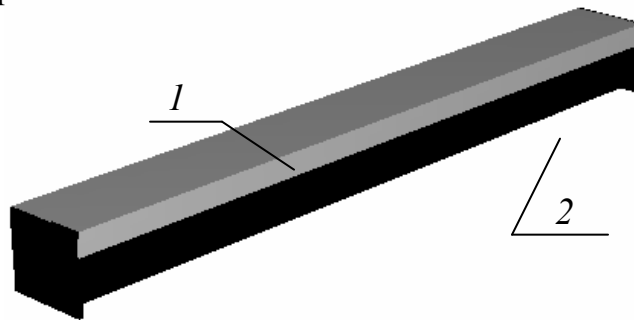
Таврова сталезалізобетонна балка з армуванням листами
